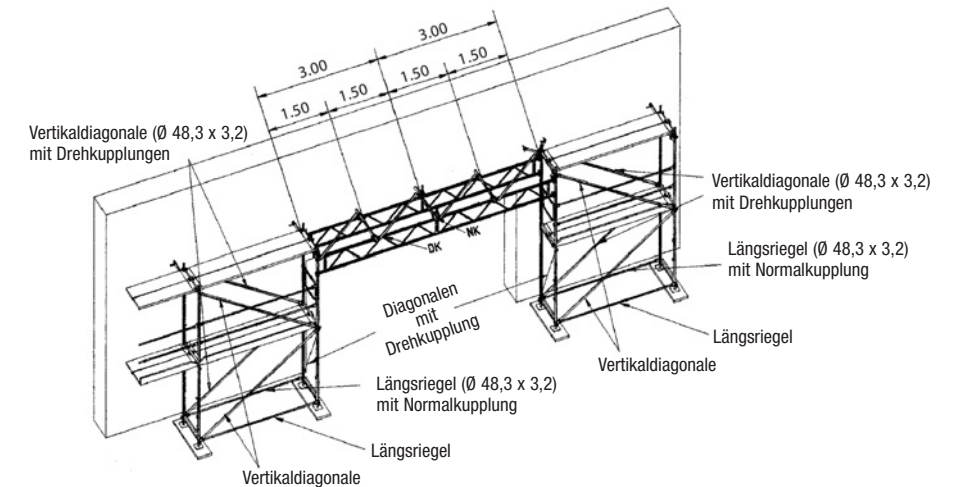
Aussteifung der Obergurtebene durch Horizontalverband; Gerüstfeldlänge l = 3,00 m (nur für unbekleidete Gerüste)
